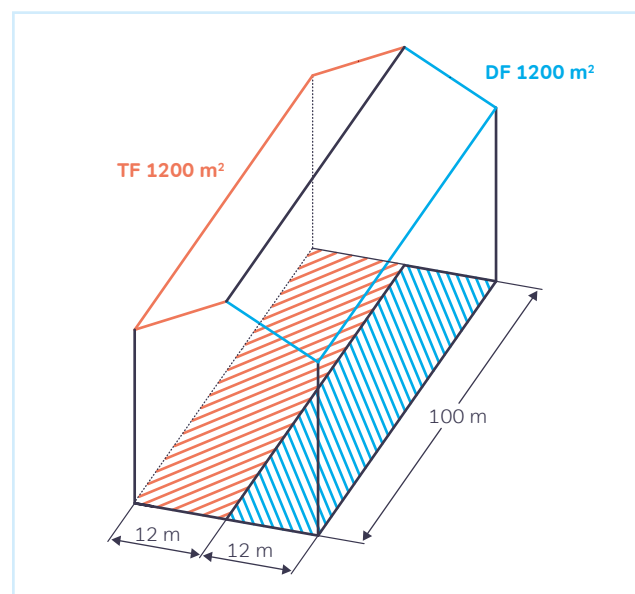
Superficie útil de la cubierta proyectada en planta según EN 12056.
